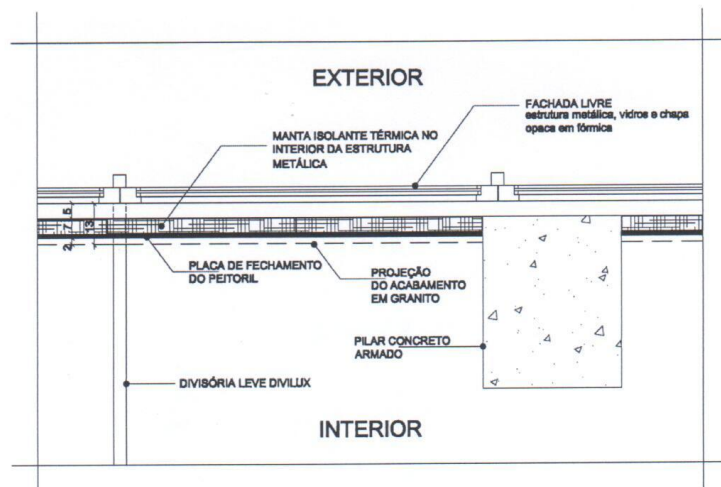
Detalhe fachada Leste – pl. baixa cortada acima do peitoril – 2016
